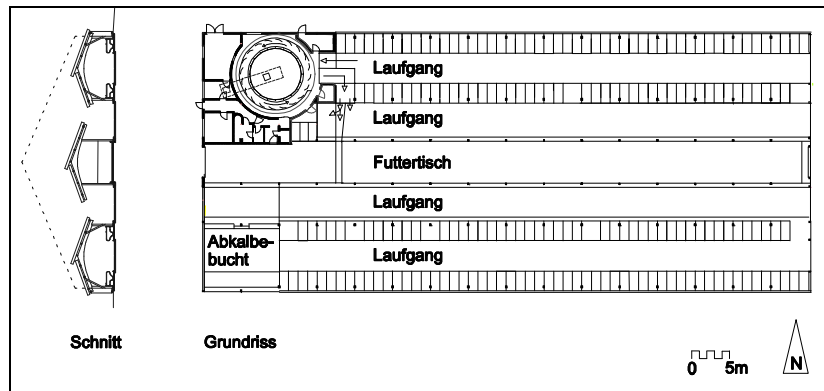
Grundriss und Schnitt des Betriebes Kufner und Naiser, Bindlach.
